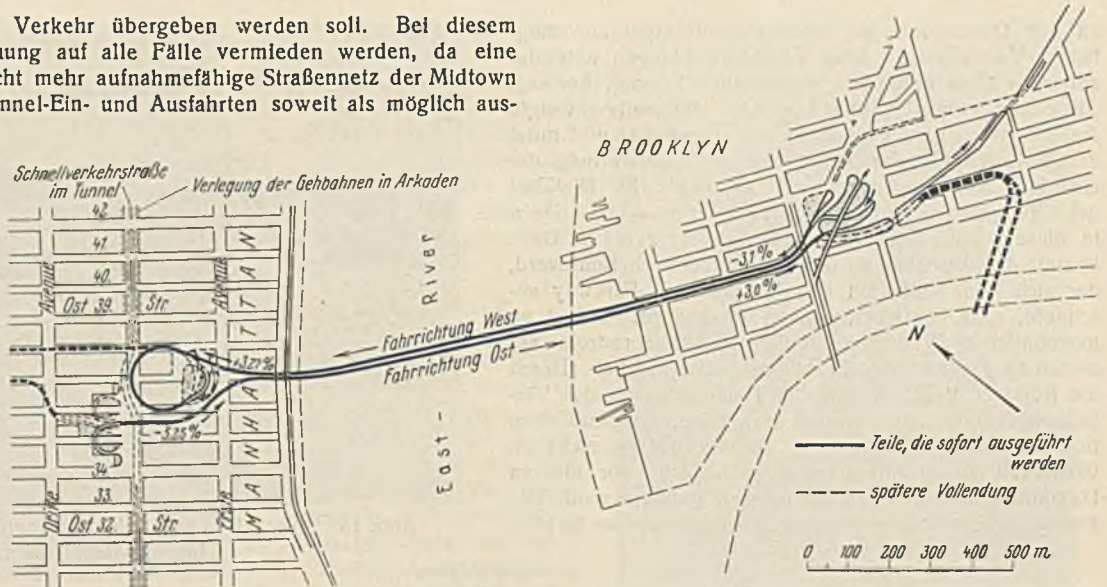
Midtown-East River-Tunnel. Lageplan mit Anschlüssen.
